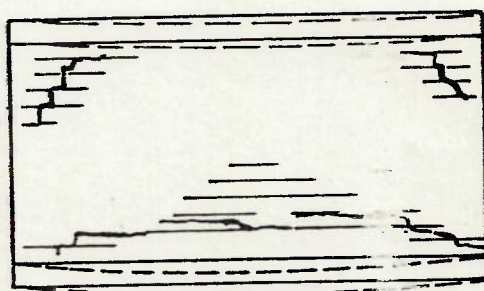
Trincas em parede de vedação: deformação do suporte maior que a deformação da viga superior
